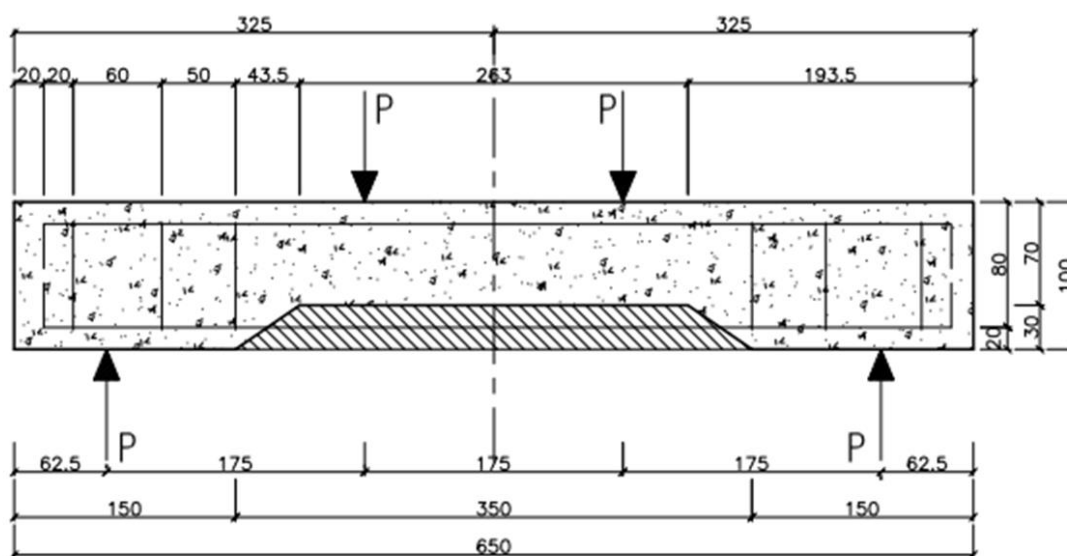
Esquema das vigas utilizadas nos ensaios de tração na flexão a quatro pontos (dimensões em mm).
